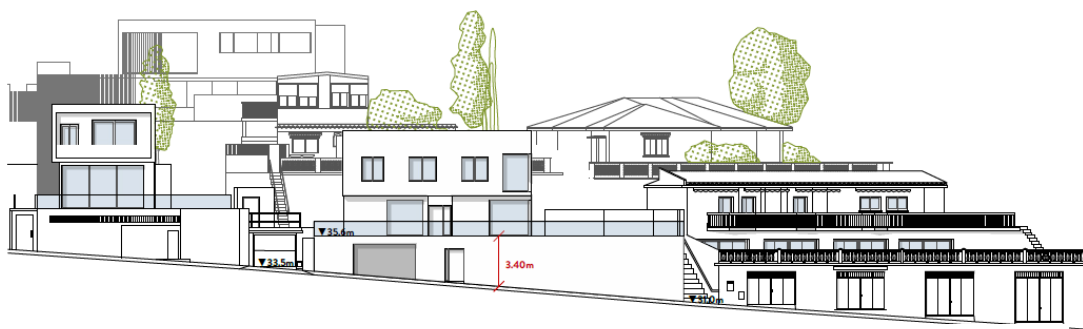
Alzado de la calle. Integración de la edificación propuesta.
